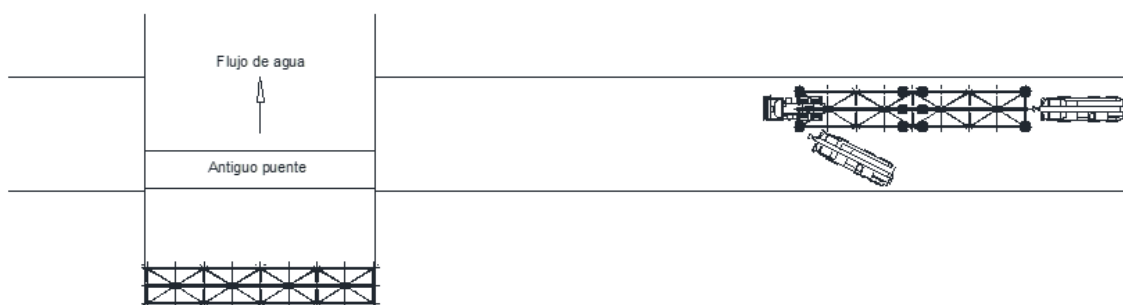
Primer trio de vigas metálicas en su posición final aguas arriba
